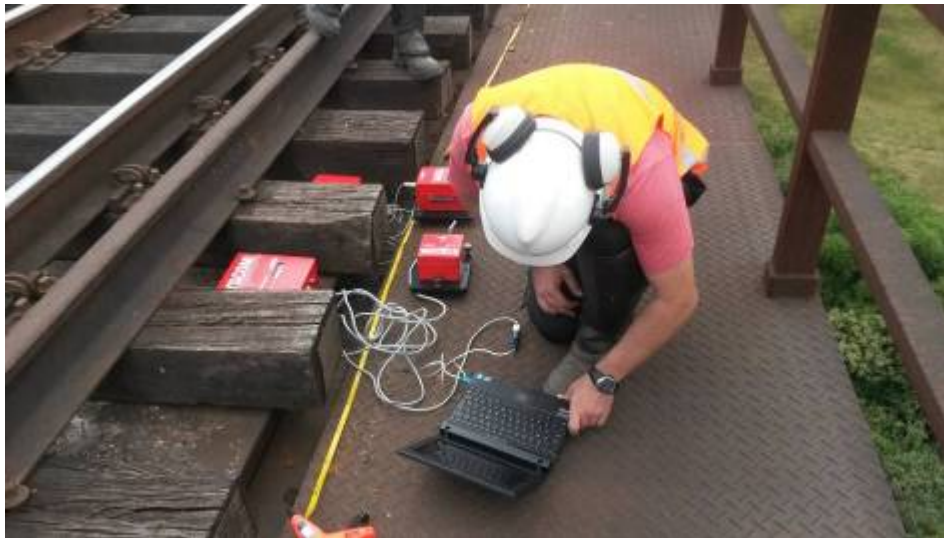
Instalação do equipamento na posição 1/3 do vão
